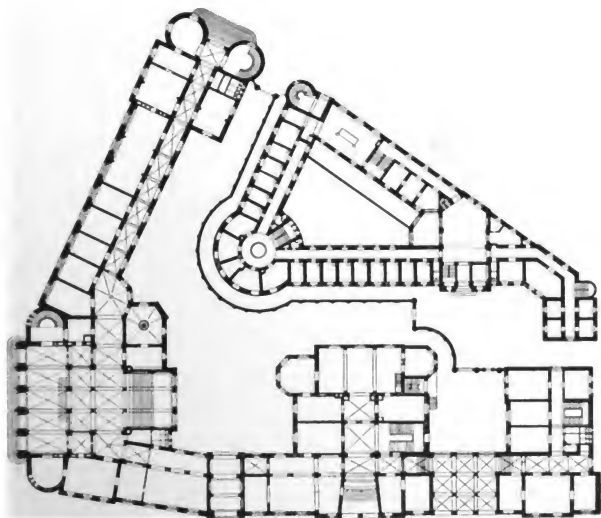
Gerichtsgebäude. Grundriß des Erdgeschosses.
